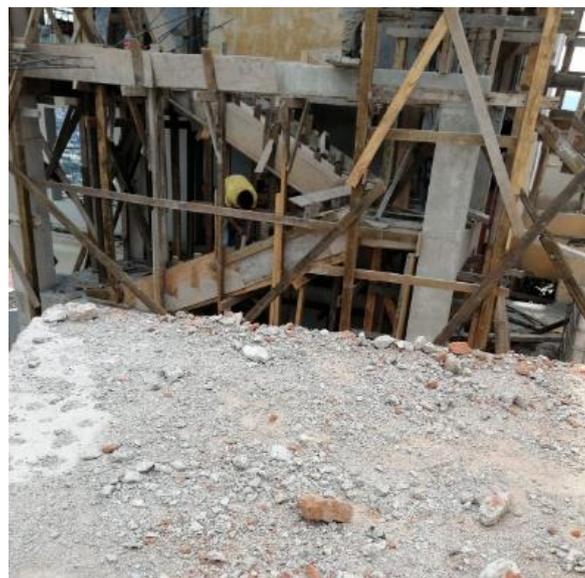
Colocación de anillos y encofrado de otras 2 columnas de gradas
